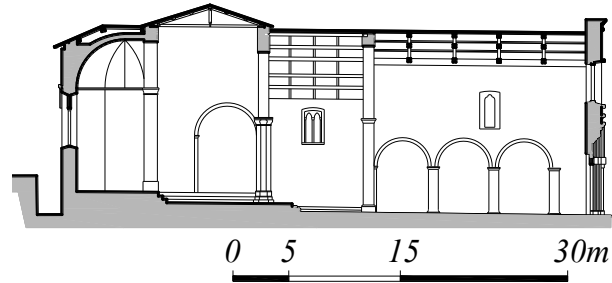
Chiesa di S. Pietro di Coppito: Sezione longitudinale
